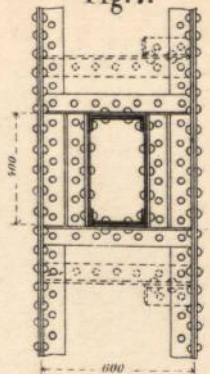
Grundriss bei Punkt a Schnitt g-h (Fig.5.)
